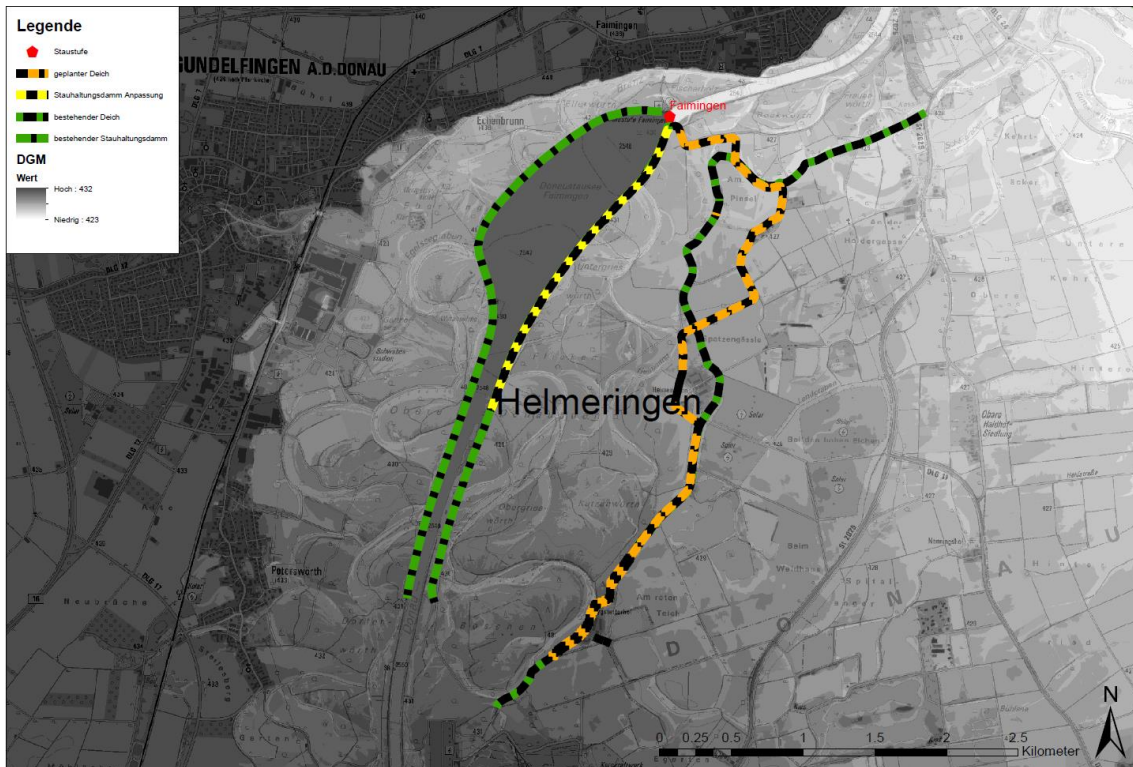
Lageplan Rückhalteraum Helmeringen, ROVar A
